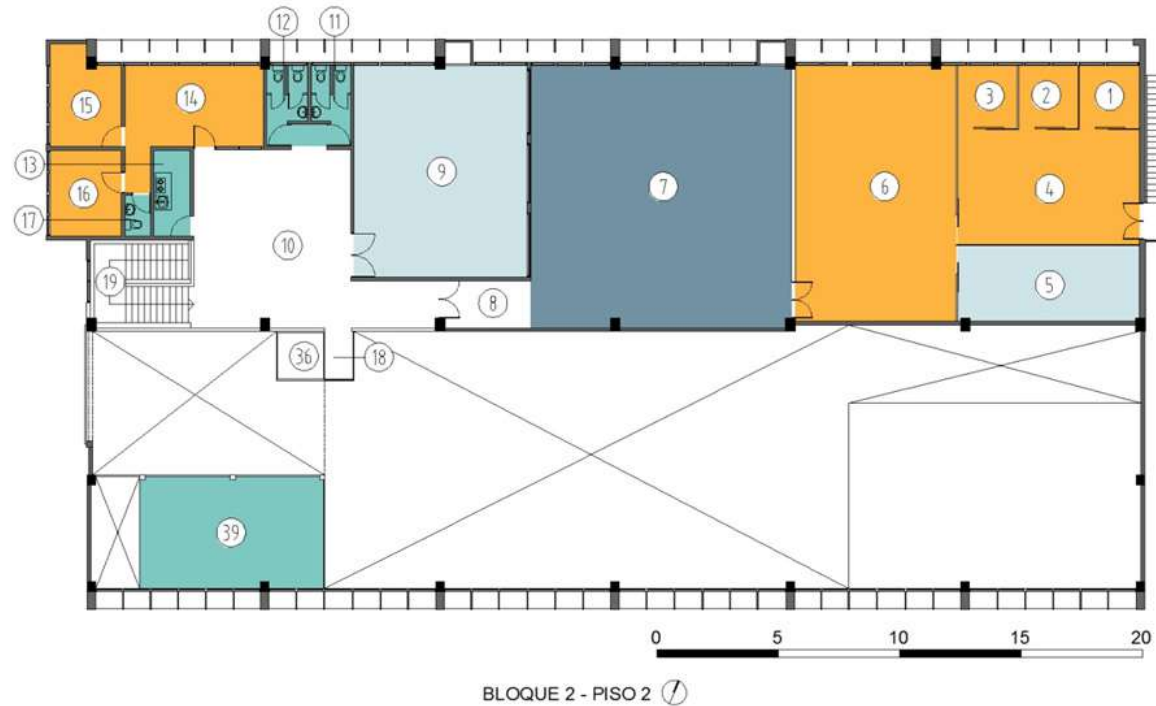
Planta Segundo Nivel Bloque No.2
